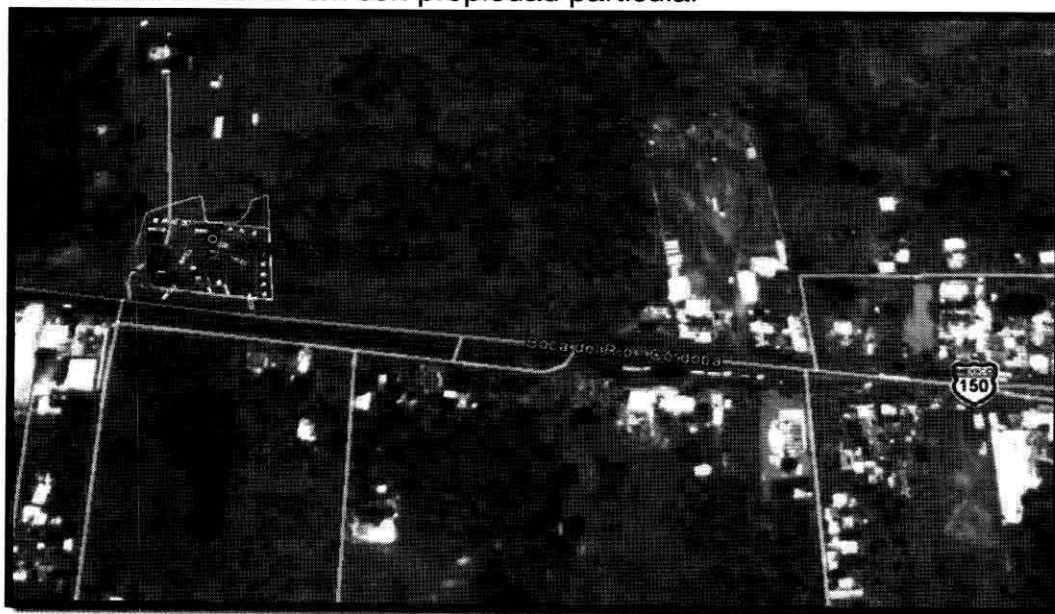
Sobre posición del plano de proyecto en el predio destinado para la construcción.
